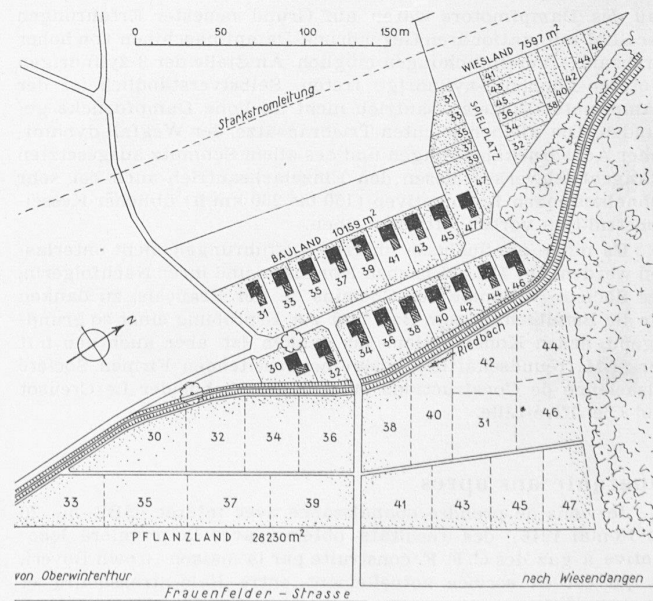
Lageplan mit Nummerierung der zusammengehörigen Parzellen, Masstab 1 : 4000
